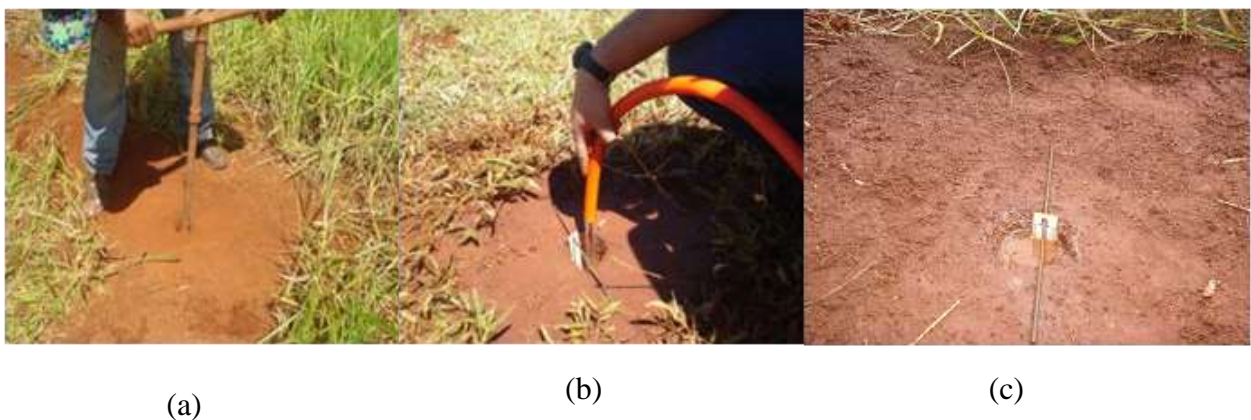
Ensaio de infiltração por rebaixamento: (a) abertura do poço; (b) abastecimento do poço até o nível do terreno; (c) realização do ensaio.
